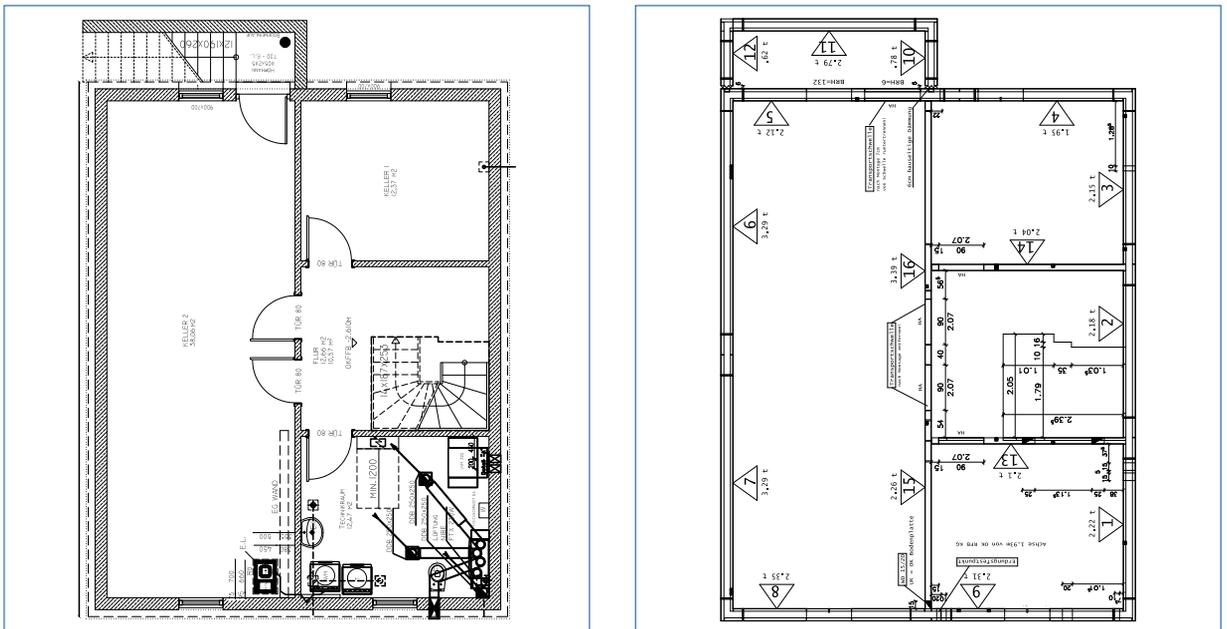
Umwandlung des Untergeschosses eines Einfamilienhauses von Ortbetonbauweise (links) in Elementwandbauweise (rechts)
